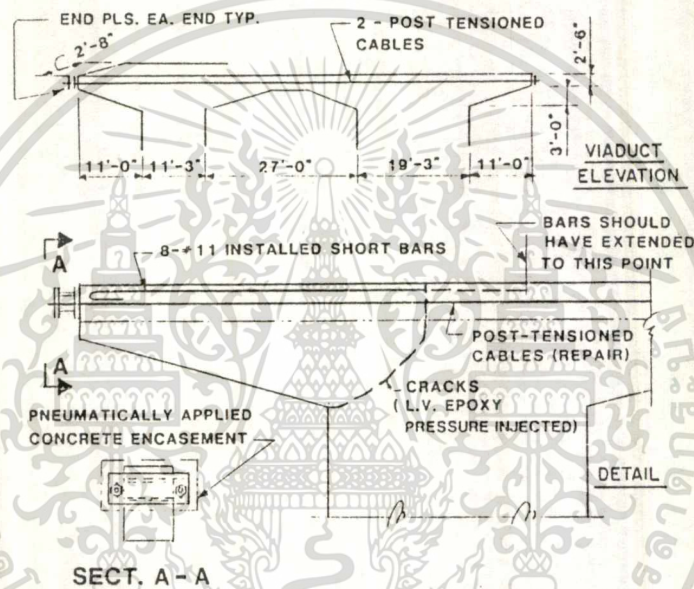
แสดงคานภายหลังจากการซ่อมแซม
